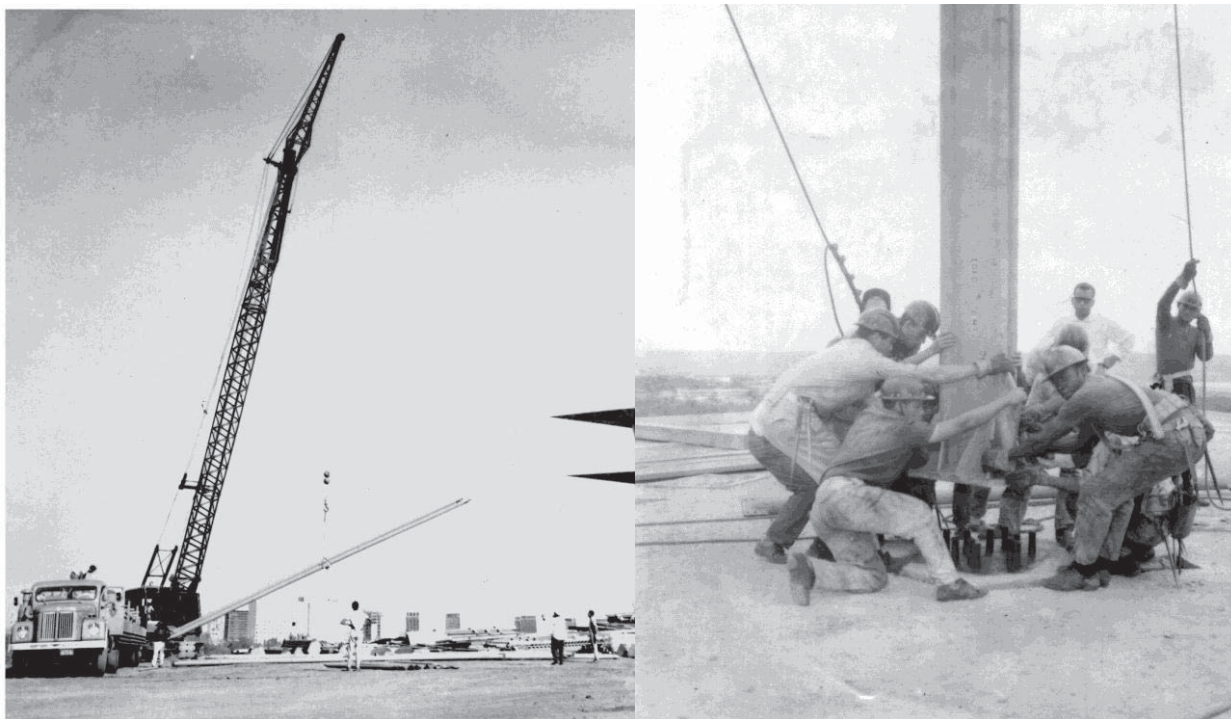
Início da montagem da estrutura metálica da Torre de Televisão (Fonte: ArPDF, Nº:1537 e 1532, Conteúdo:Construção da Torre de TV).
